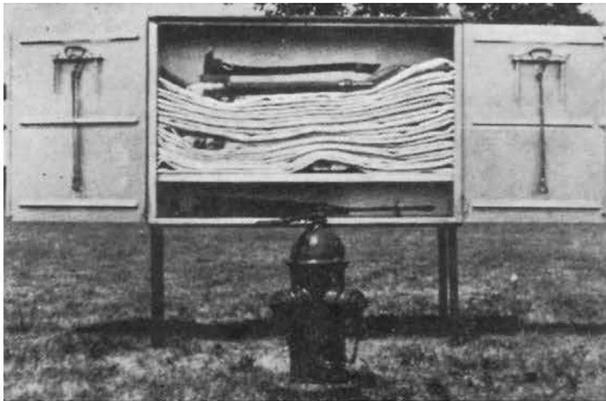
(c) Caseta de mangueras que puede ser instalada sobre patas, como se muestra en la figura, o sobre un muro cercano a, pero no directamente sobre, un hidrante privado.
